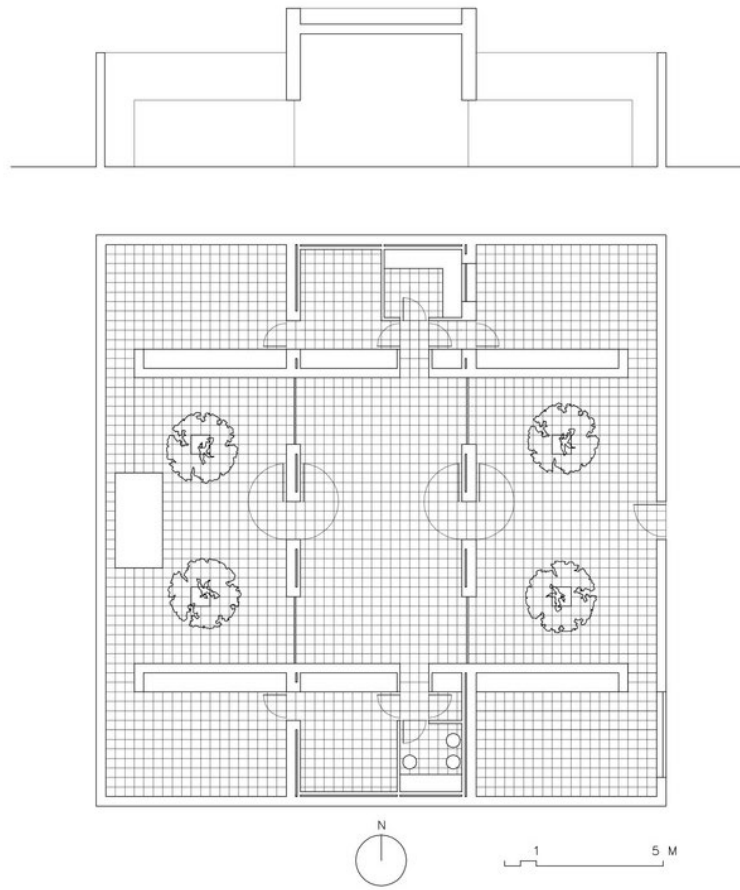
Planta de distribuição da Casa Gaspar de Campo Baeza
